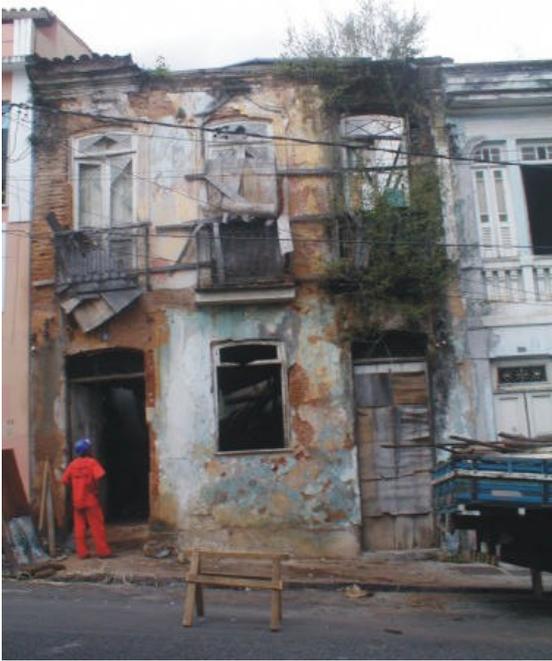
Foto de ruína existente no local semelhante às utilizadas
